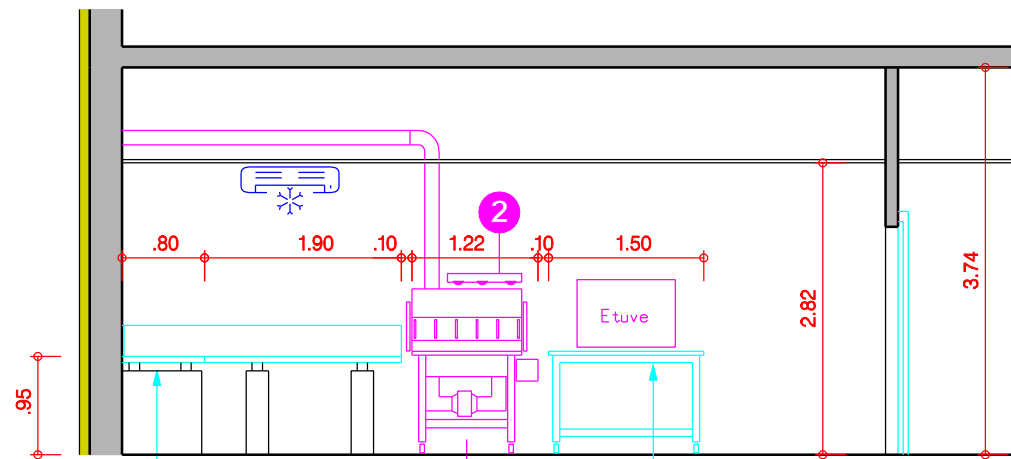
DETAIL DES PLANS DE TRAVAIL ET DU PIED A DEMOLIR
